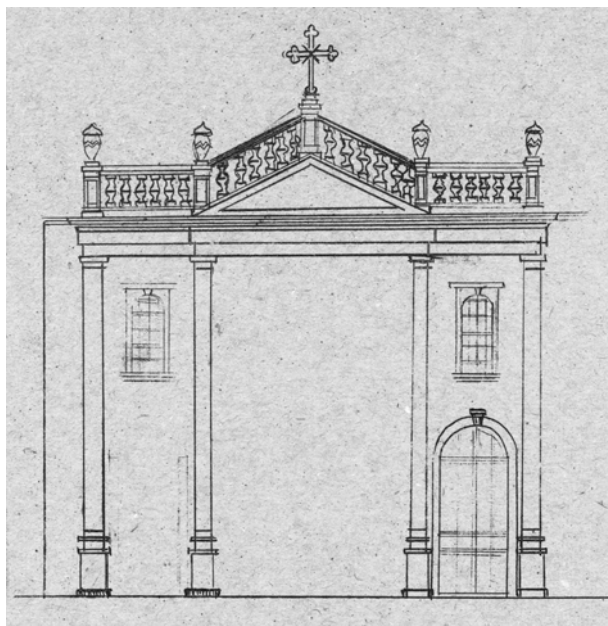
Tunja - Iglesia Mayor. La fachada de piedra.
